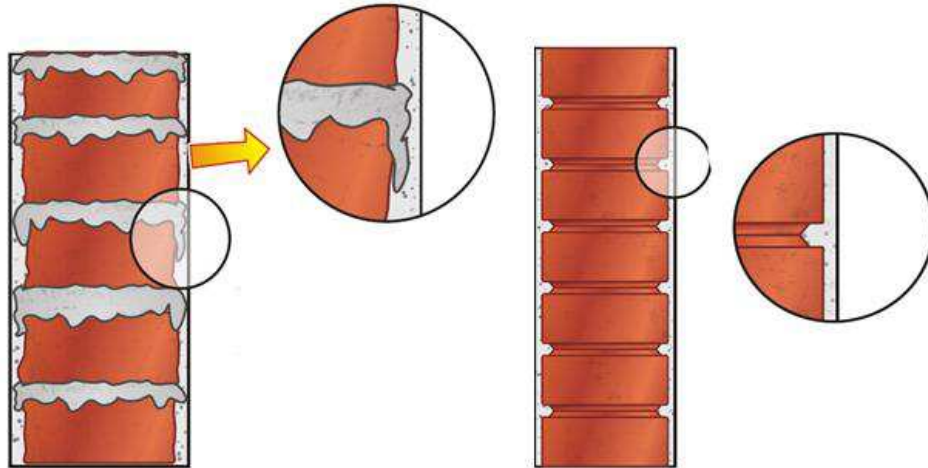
Acabamentos de paredes: Tijolo cerâmico x tijolo solo-cimento.
